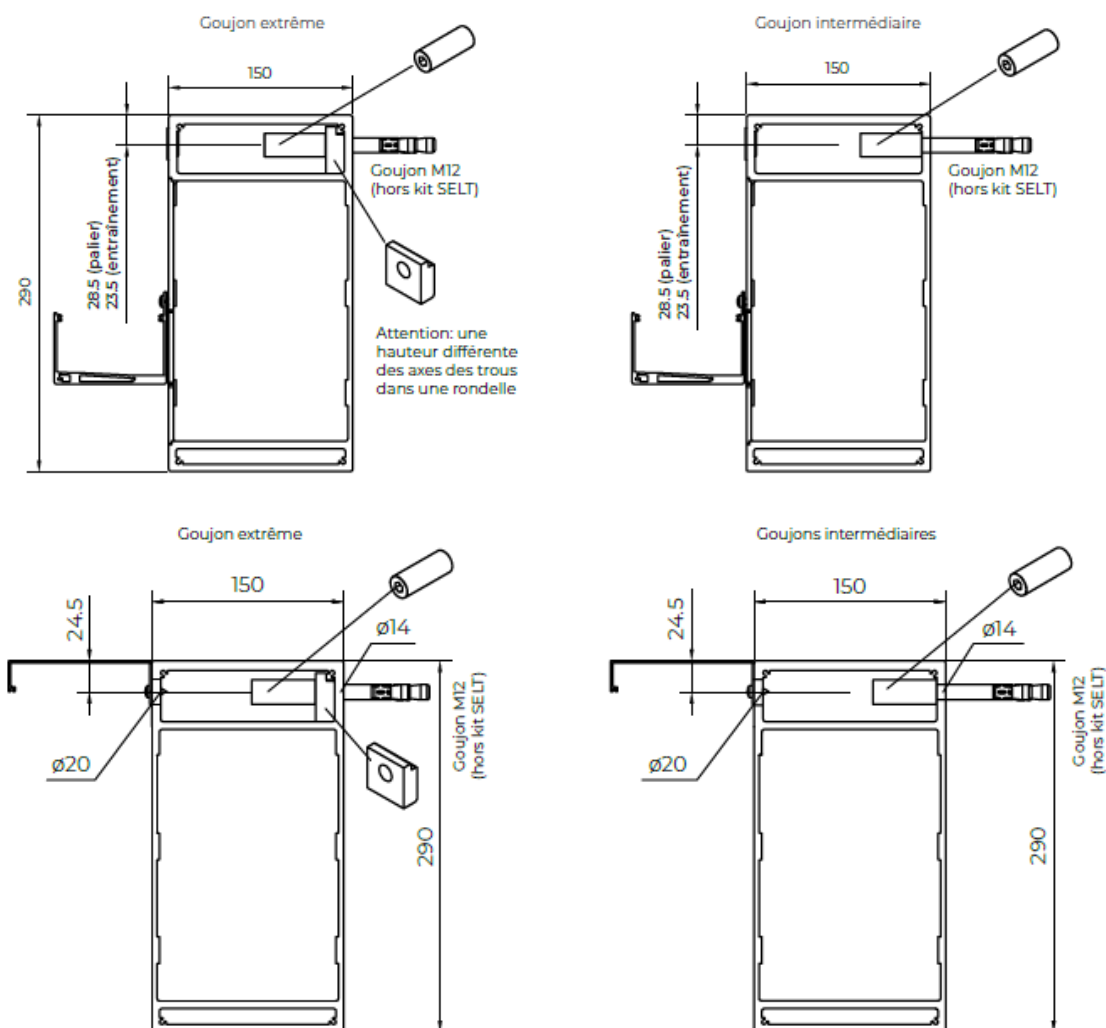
Coupes transversales des ancrages muraux SELT (en haut - poutre longitudinale, en bas - poutre transversale)
